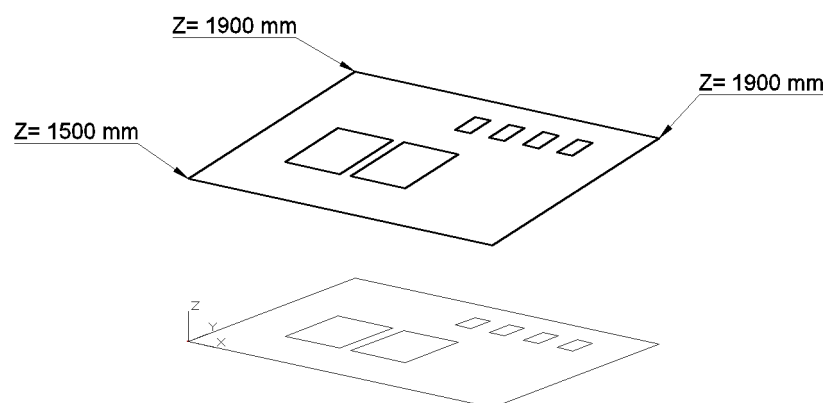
Grundrissfläche und projizierte Fläche im Raum
